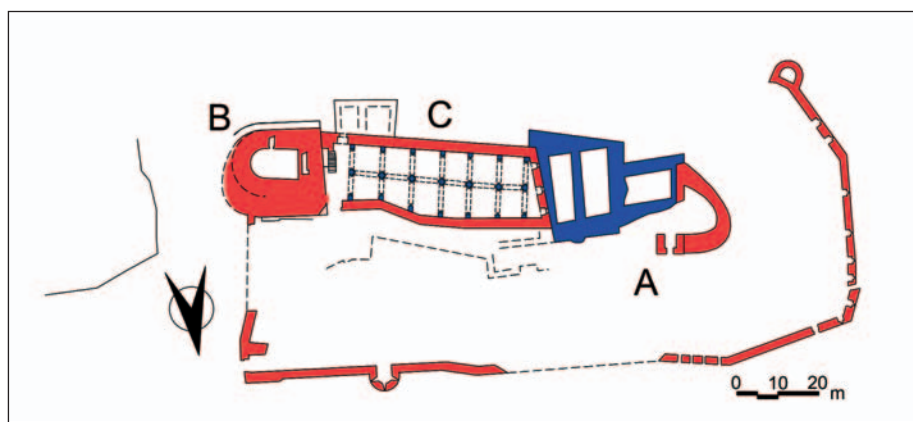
Montfort, plan du château (dessin J. Mesqui d'après D. Pringle).
